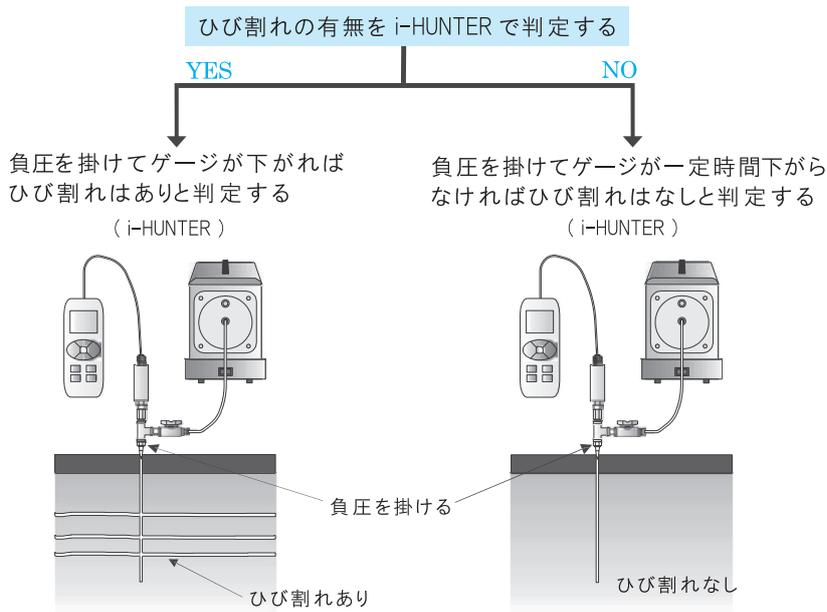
i-HUNTER (ひび割れ有無判断基準)
